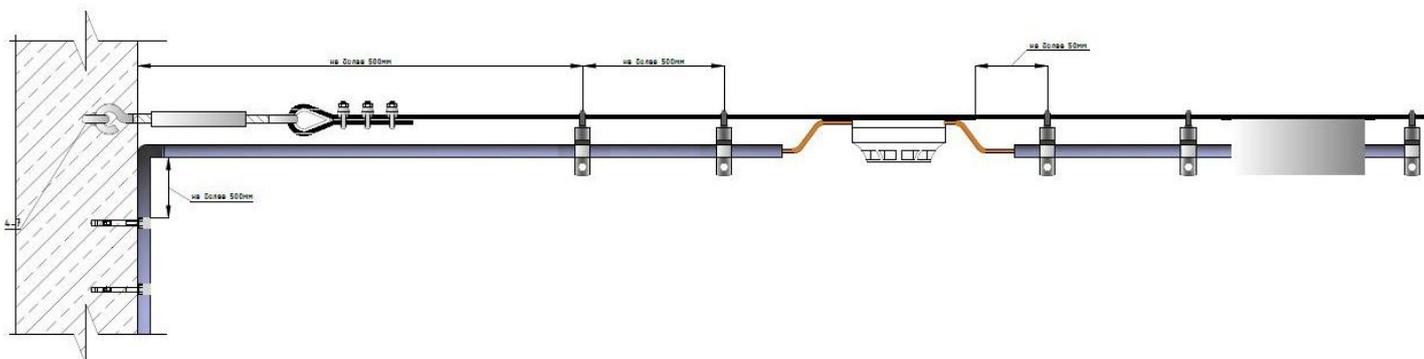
б Схема монтажа подвеса с помощью рым-болтов и струбцин монтажных для труб
